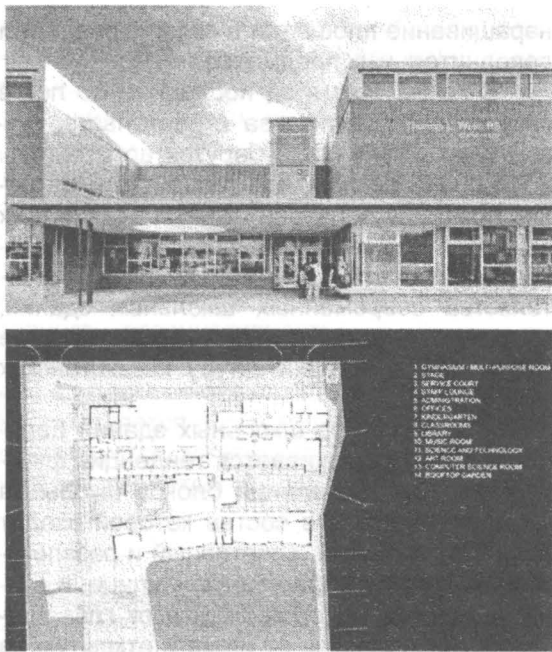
; Фрагмент фасада, план 1 этажа
